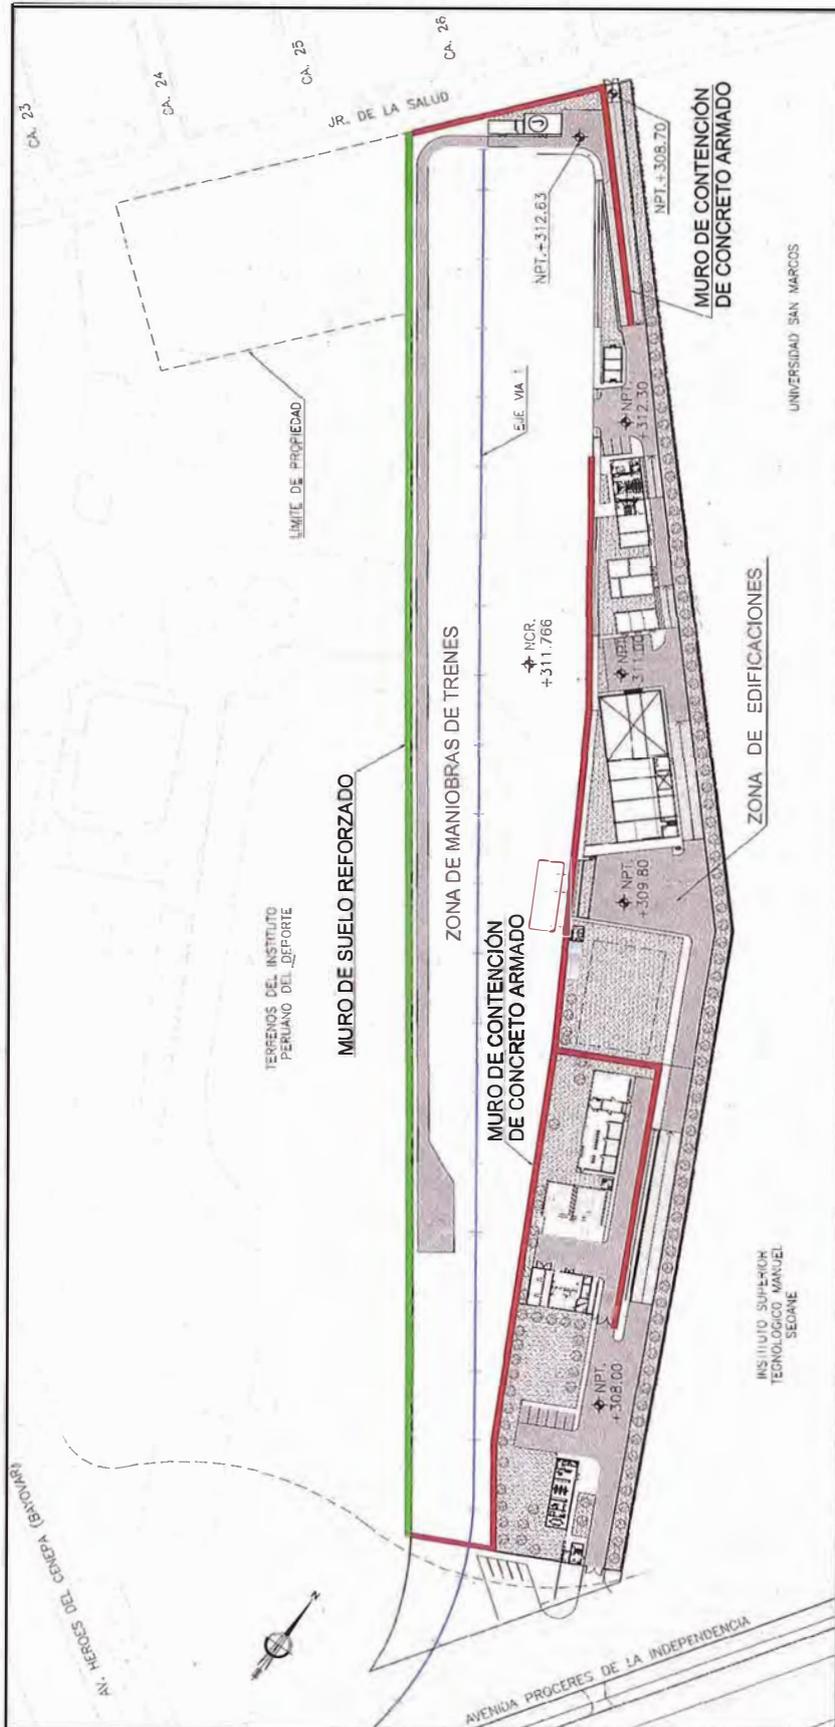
Patio de Maniobras – Ubicación de muro de suelo reforzado.
